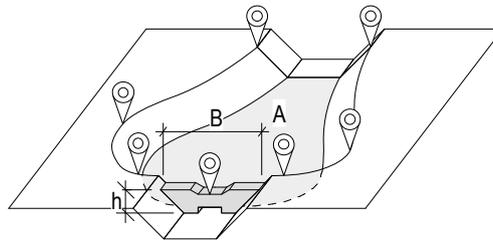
Skizze Geschieberückhaltebauwerk mit Rückhaltefläche.
